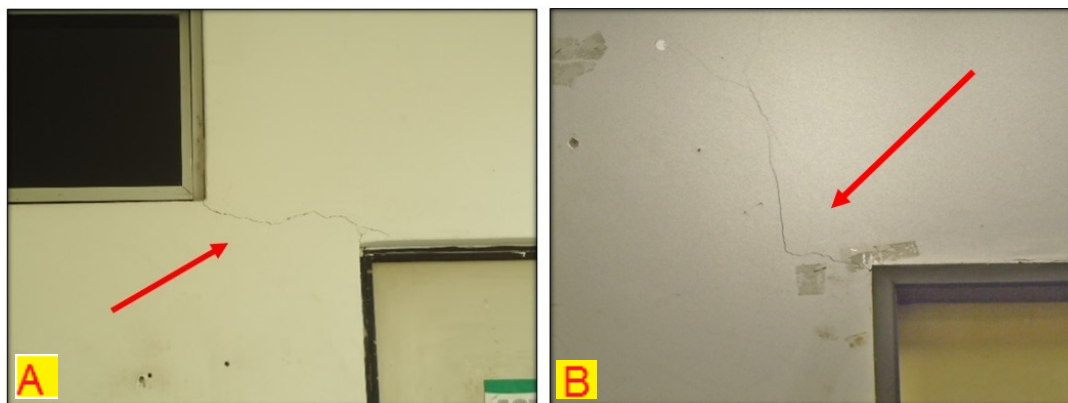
Fissuras ocasionadas por falta de vergas e contra-vergas nos vãos
